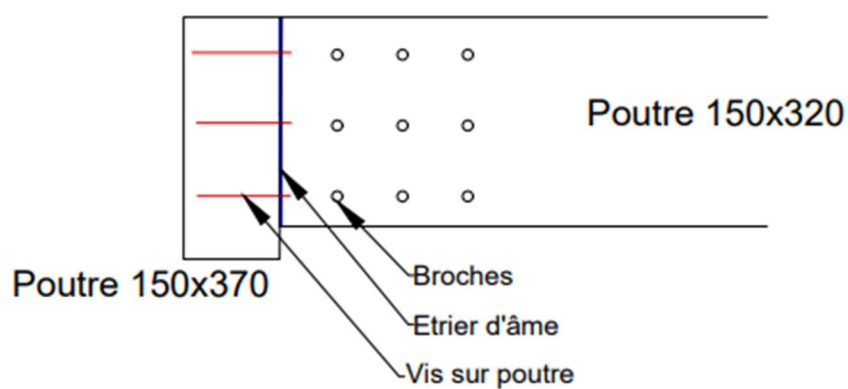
ASSEMBLAGE POUTRE INTERIEURE/ POUTRE DE FAÇADE/ VIGIE
